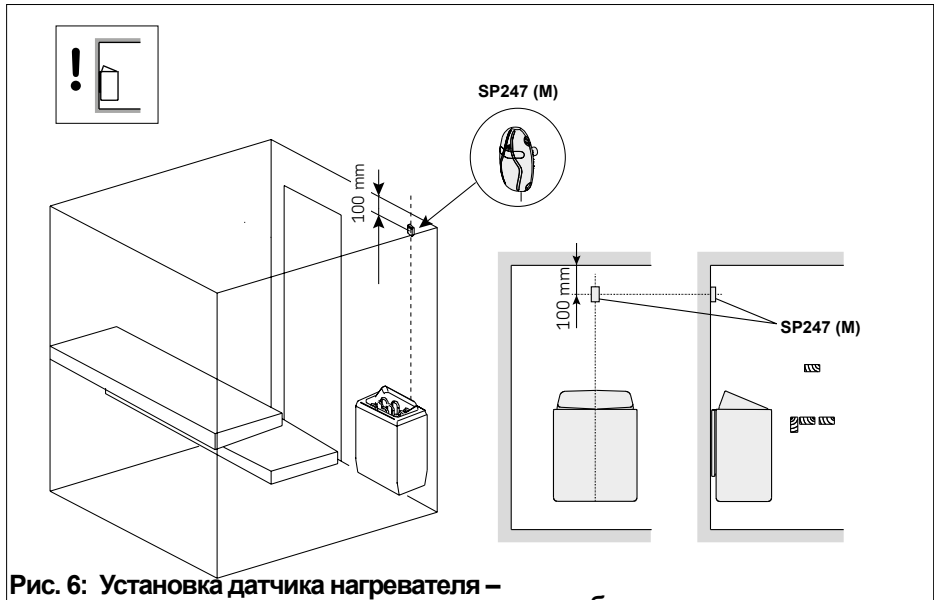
Установка датчика нагревателя – настенная модель нагревательного прибора
